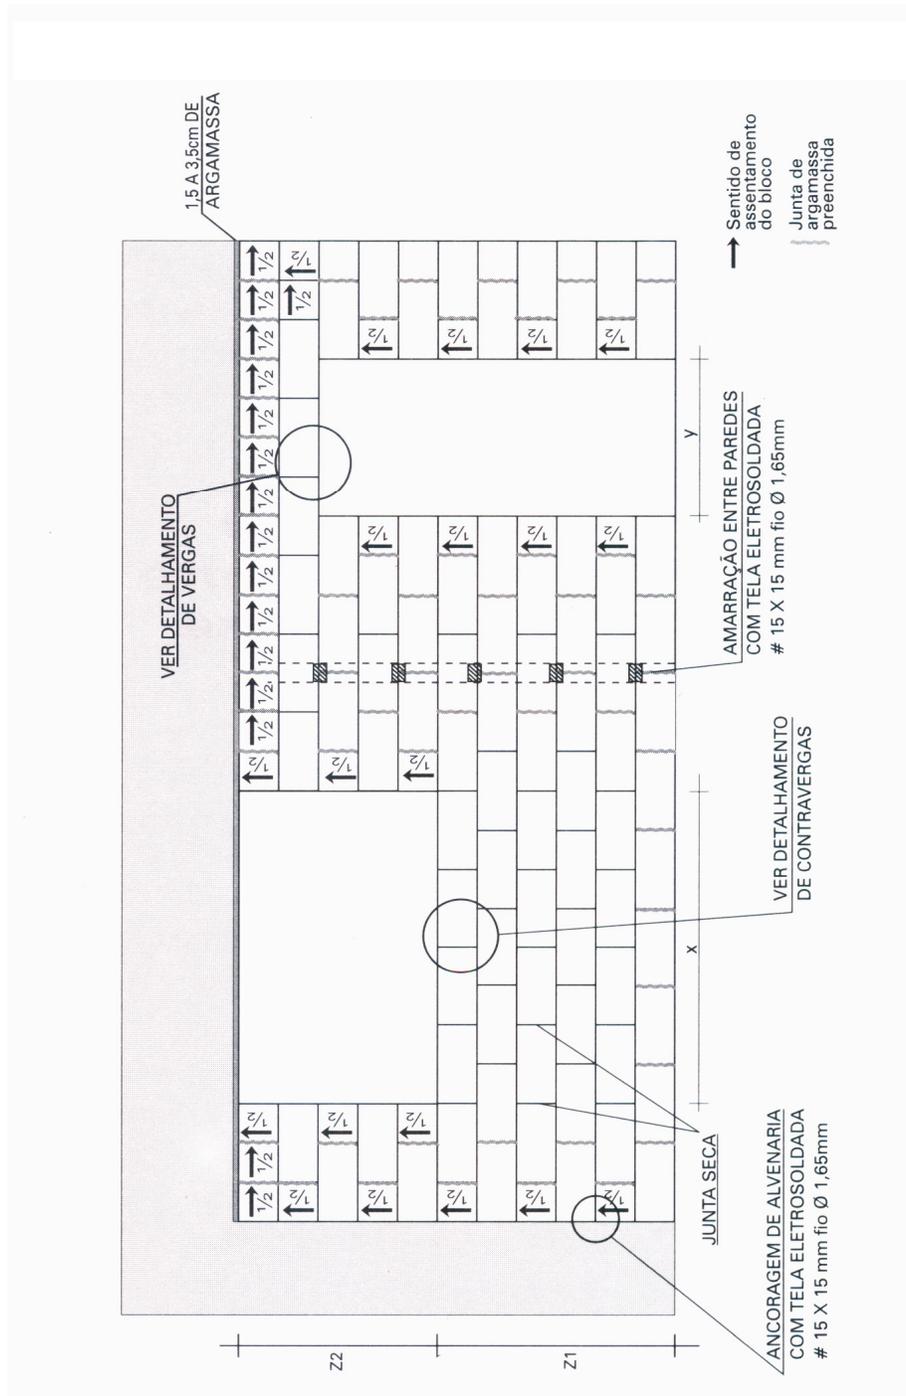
Exemplo de uma elevação de parede (detalhamento).
